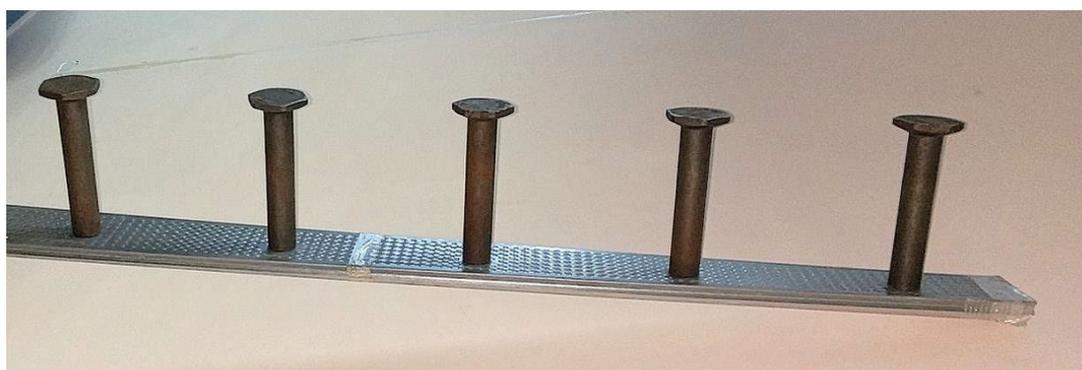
Анкерная сборка KSN в металлическом коробе.
